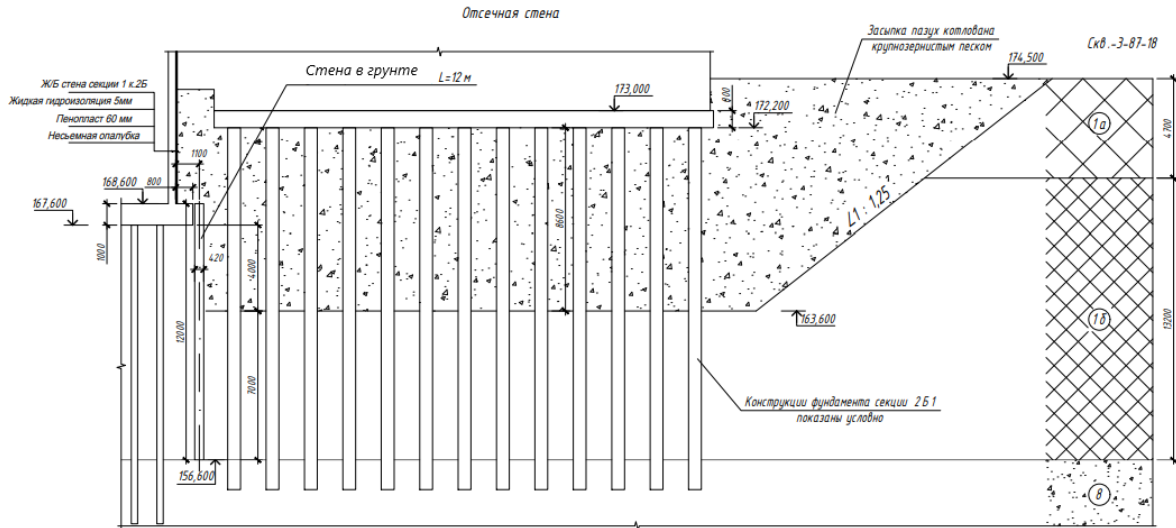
Устройство стены в грунте методом «jet grouting» при реализации газозащиты подземной части здания в зонах А и Б
